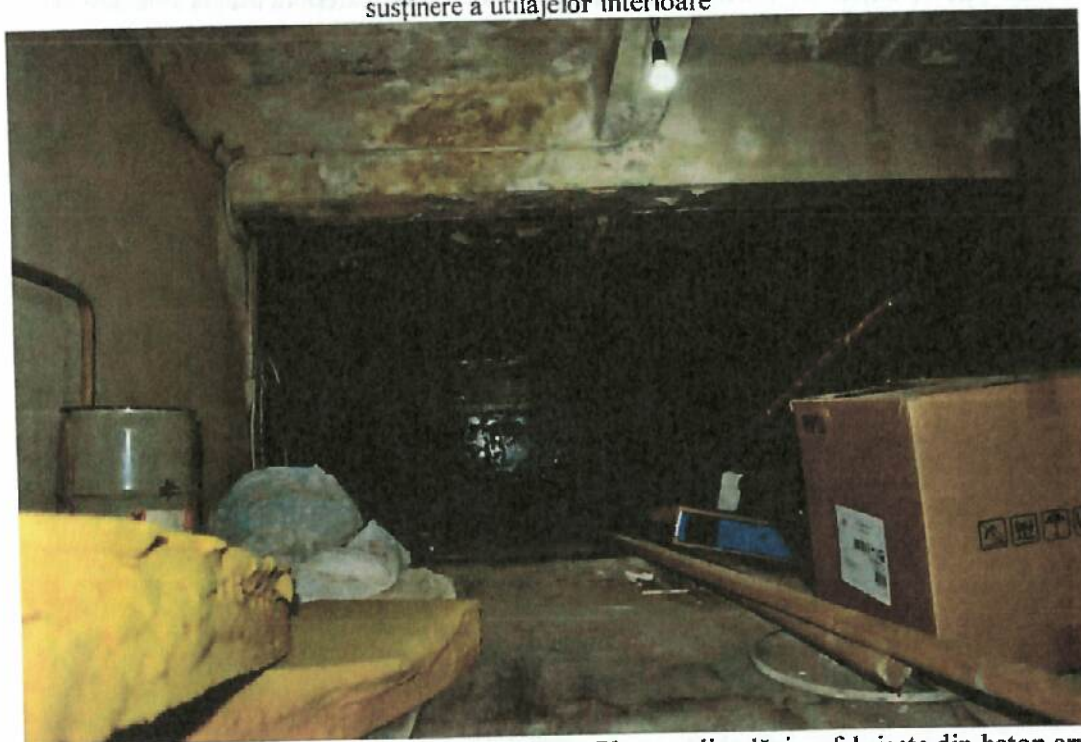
Atelier intretinere 11, Atelier turnatorie (C28): Planșeu din plăci prefabricate din beton armat
